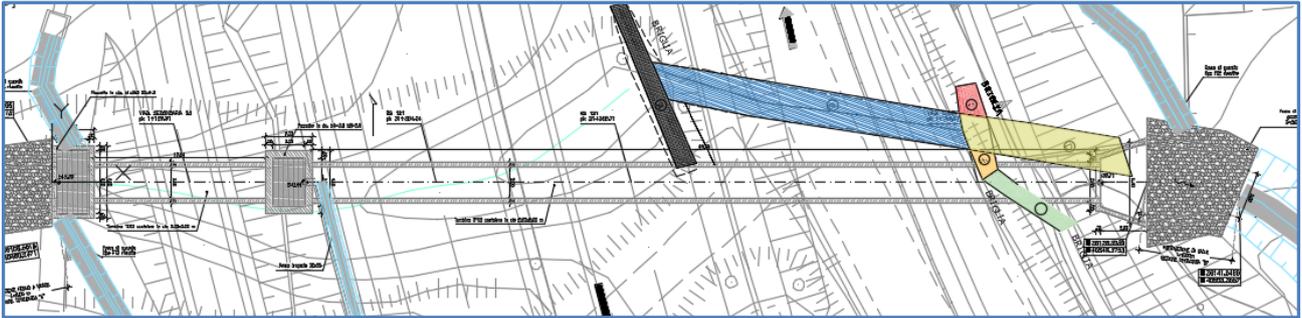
Stralcio planimetrico Tombino idraulico TP68 con manufatti in c.a. esistenti.
